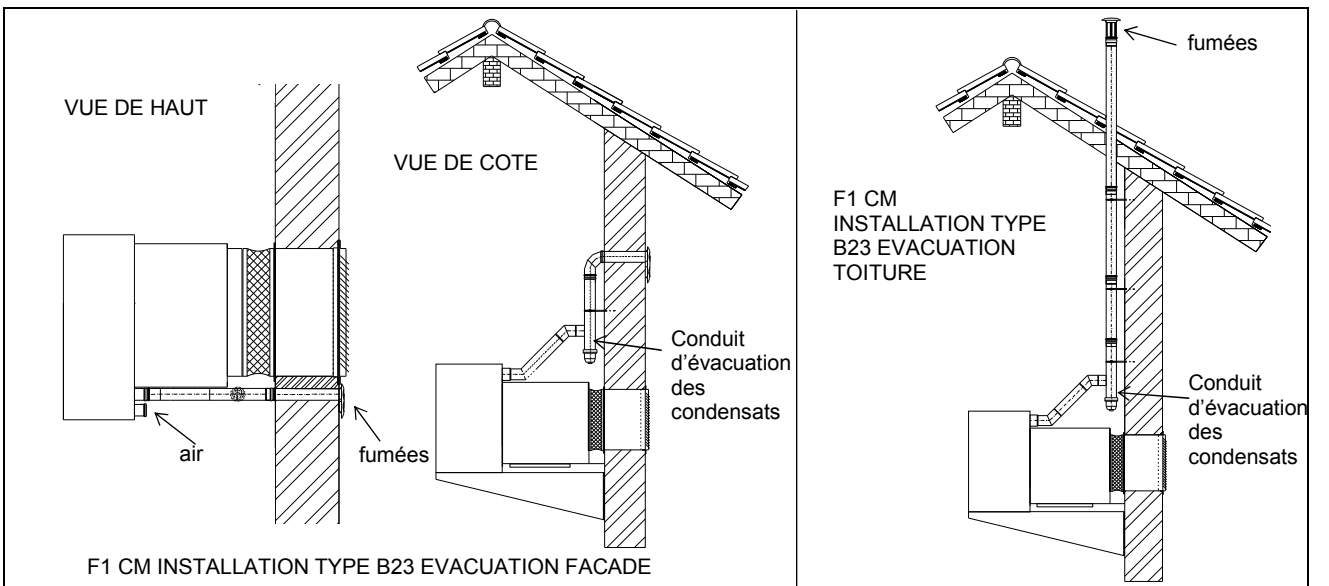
F1 CM INSTALLATION TYPE B23: EVACUATION FACADE ET EVACUATION TOITURE
